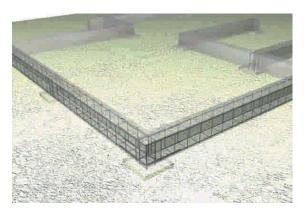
13: Viga de fundación que amarra los pilotes de hormigón y recepciona el muro perimetral de la vivienda.
